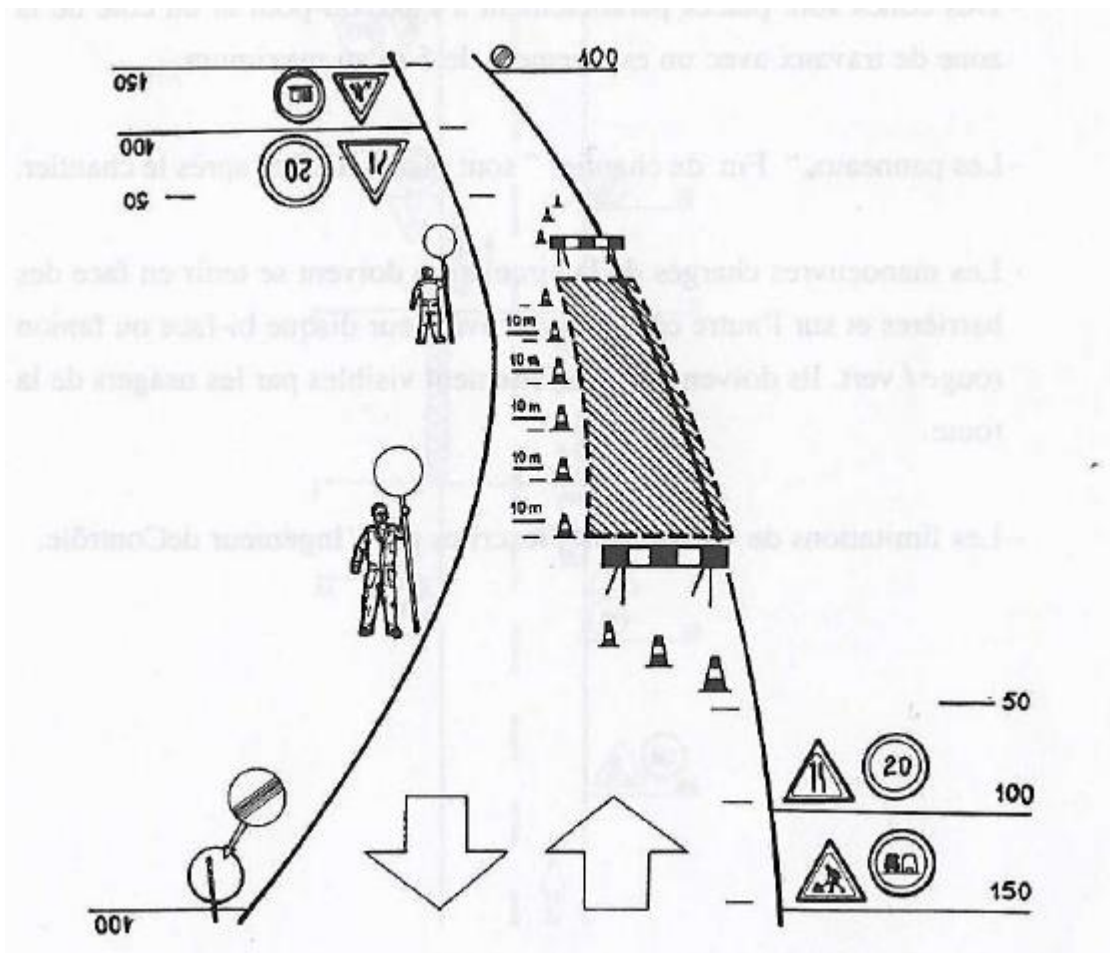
Plan de gestion de trafic pour les travaux en demi-chaussée des voies carrossables
